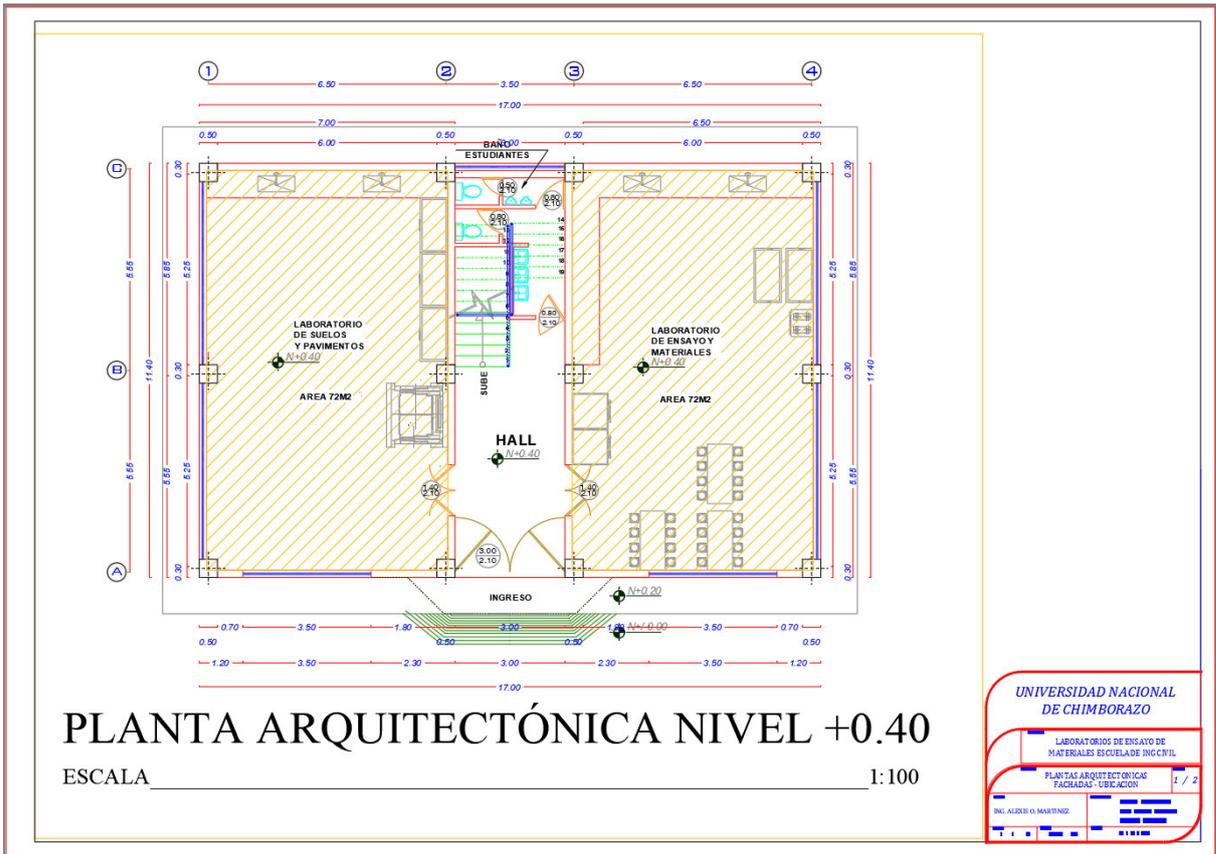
Planta arquitectónica Laboratorios de ensayos de materiales. Universidad Nacional de Chimborazo.
